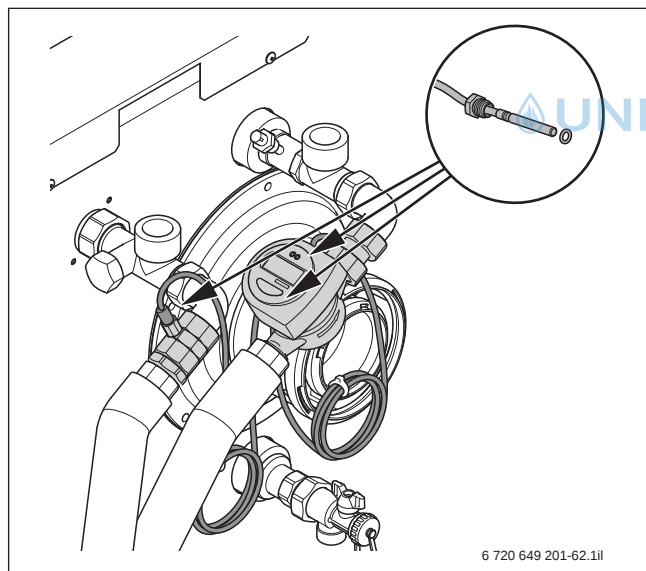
Einbauposition Anschluss-Set Wärmemengenzähler
